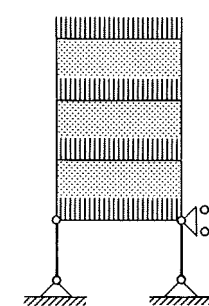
Konstruktionsmodel for lodret last på traditionel elementbygning. Simpelt understøttede plader og simpelt understøttede, brede søjler.
